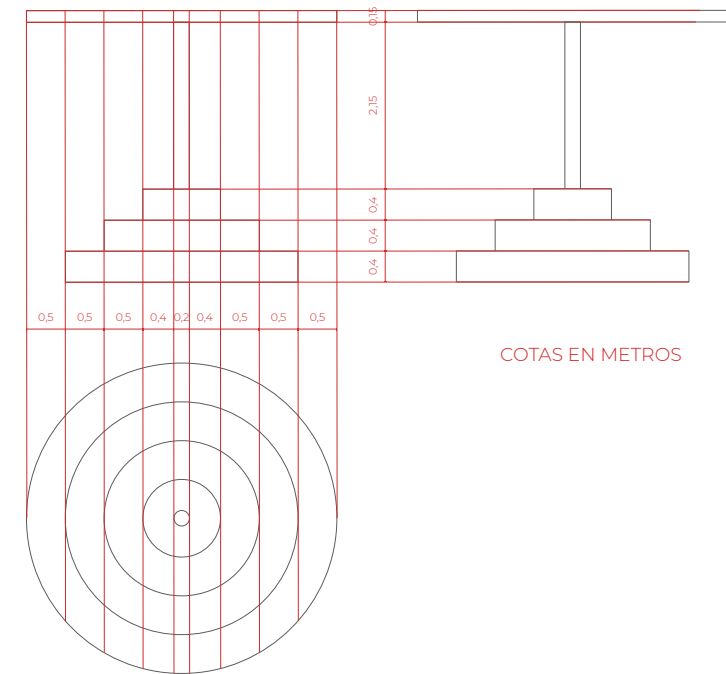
Dibujo Constructivo V. Estructura blanca, elaboración propia.
